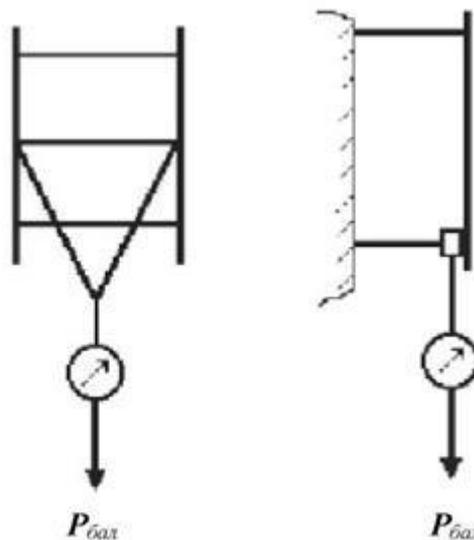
Схема приложения испытательной нагрузки для балки
